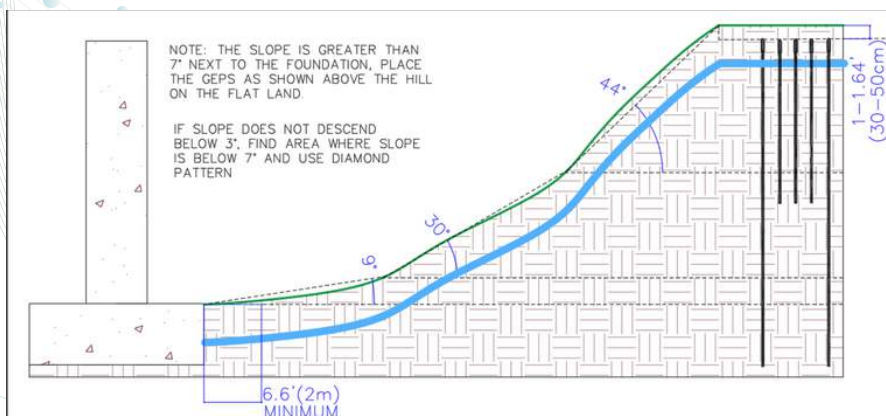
Przykład przekroju poprzecznego systemu GEPS zainstalowanego w pobliżu fundamentu z uwzględnieniem międzynarodowych przepisów budowlanych wymienionych w uwagach poniżej.
